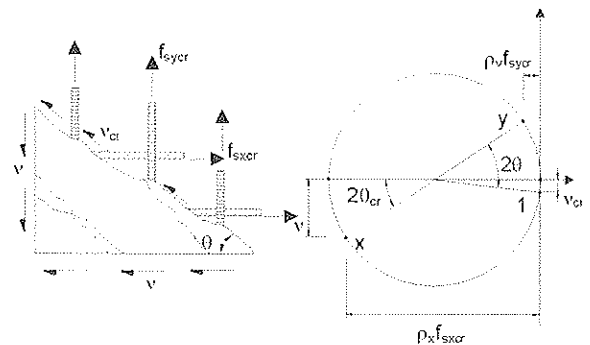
Equilibrio en términos de tensiones locales en la fisura.
